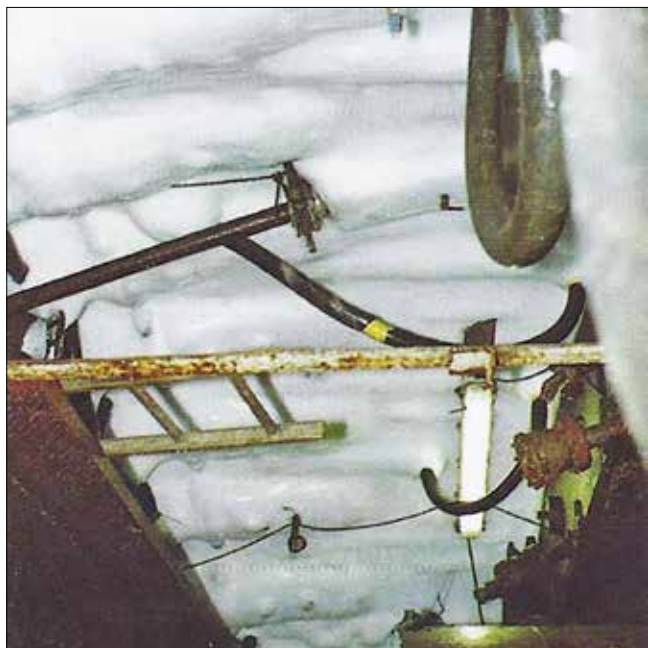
Plnění skipu suchou betonovou směsí pro zhotovení betonových sloupových inkluzí technologií průchozího ponorného vibrátoru na pražské stavbě v roce 2002 (Keller)
